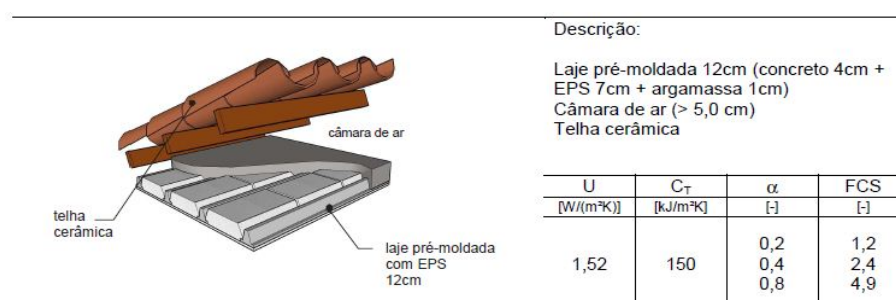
Telhado cerâmico com laje pré-moldada 12,0cm feito de concreto, EPS e argamassa (LabEEE 2010)
